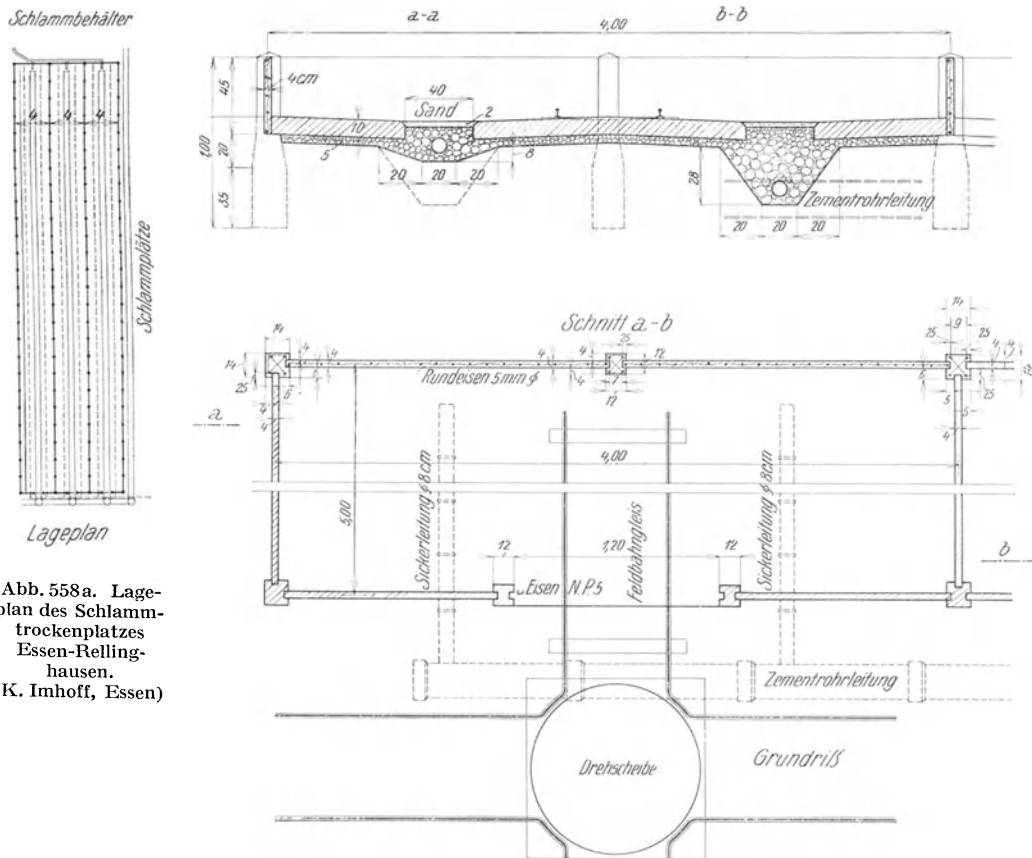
Lageplan des Schlamm-trockenplatzes Essen-Rellinghausen. (K. Imhoff, Essen)
